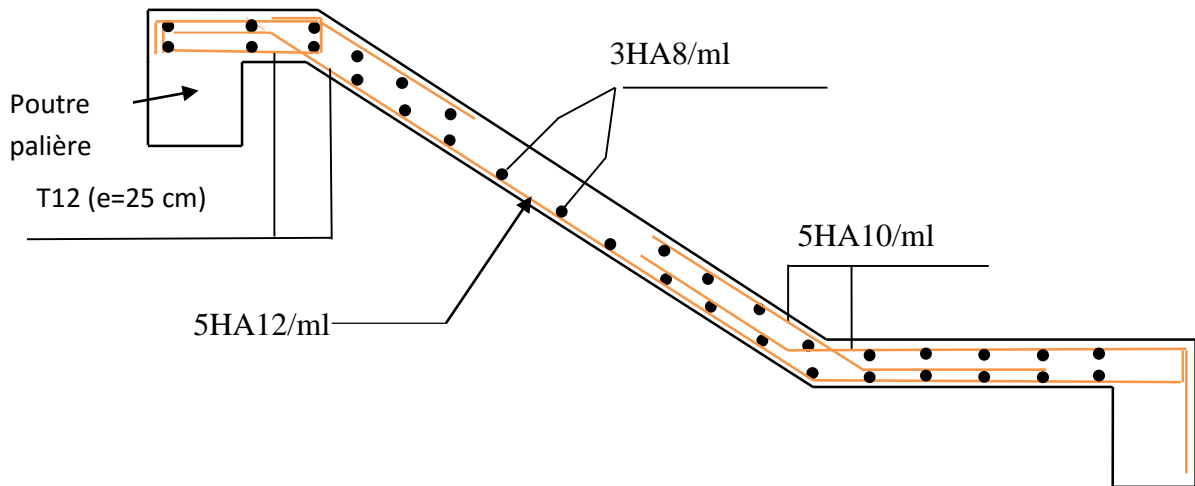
Schéma de ferrailage de la volée 1 de l'escalier.
